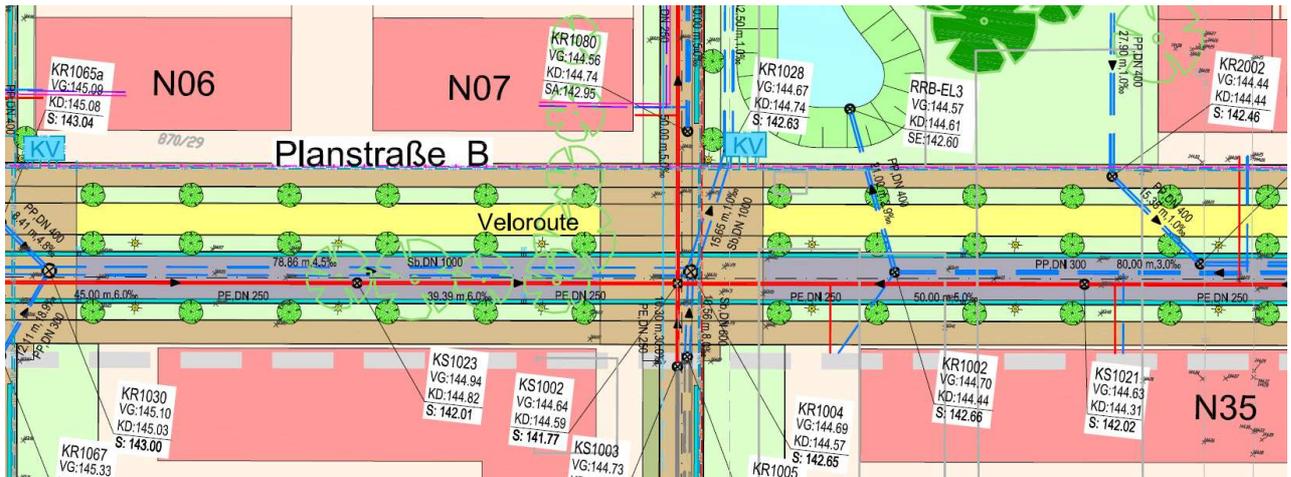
Bit Consult GmbH, Friezheimer Straße 3, 70499 Stuttgart: Ausschnitt aus der Ausführungsplanung zur Erschließung „Wohnpark Am Ebenberg“, Masterplan, Stand 21.02.2011
